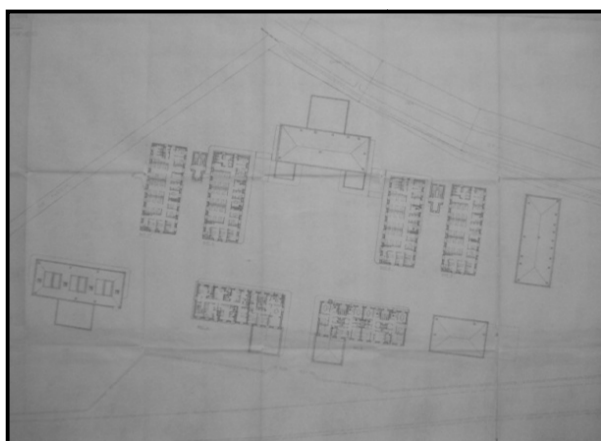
Plan d'ensemble initial- plan de l'étage.
